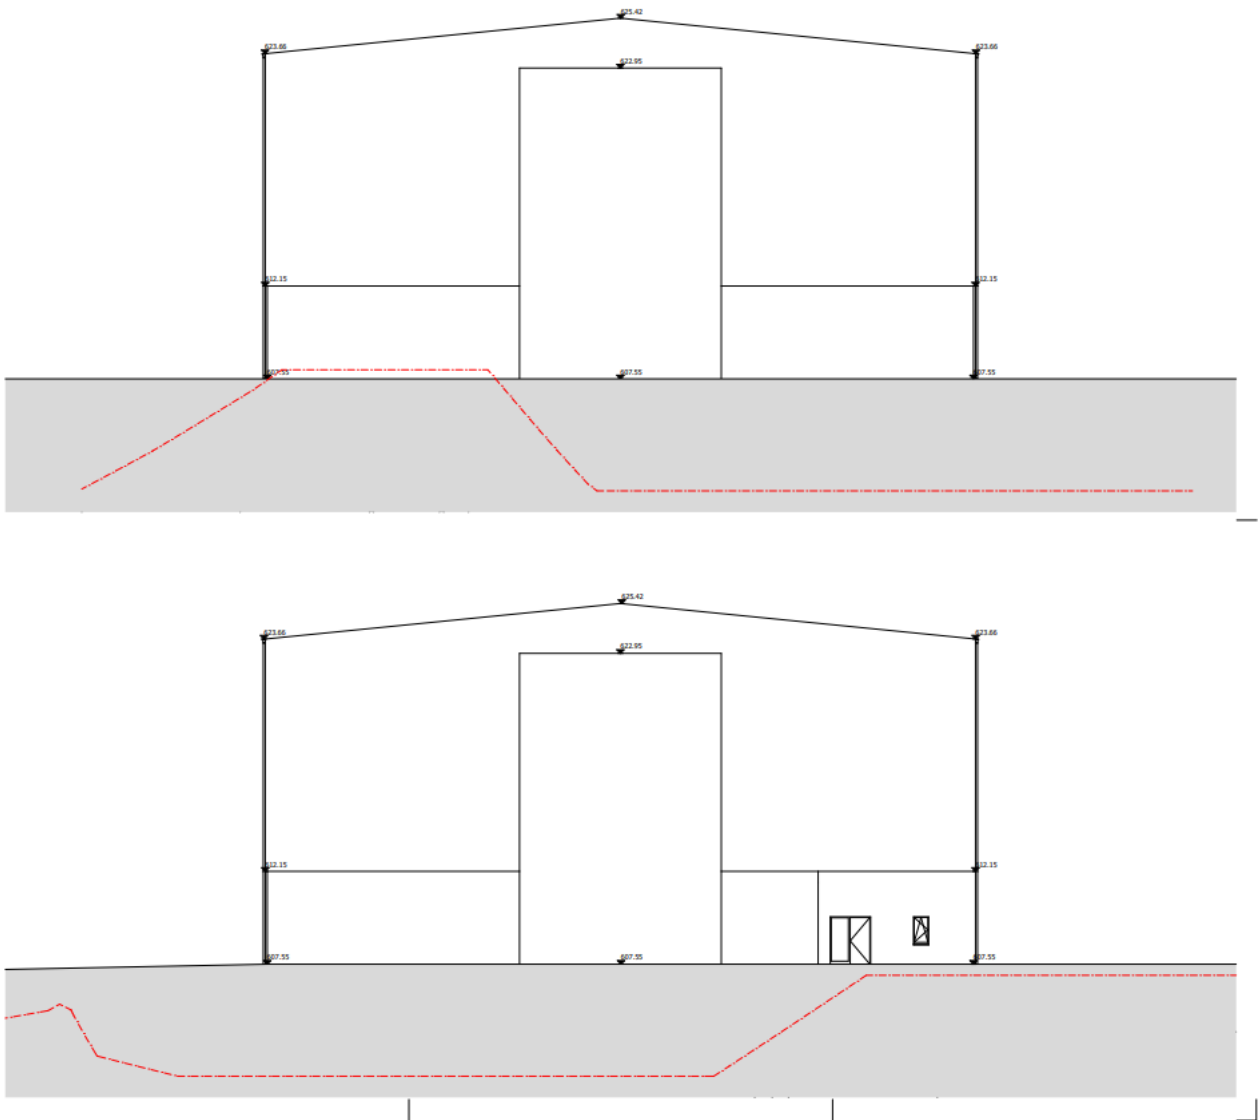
(Haut) Façade nord-ouest du hangar 10. (Bas) Façade sud-est du hangar 10. Extrait de [1].
